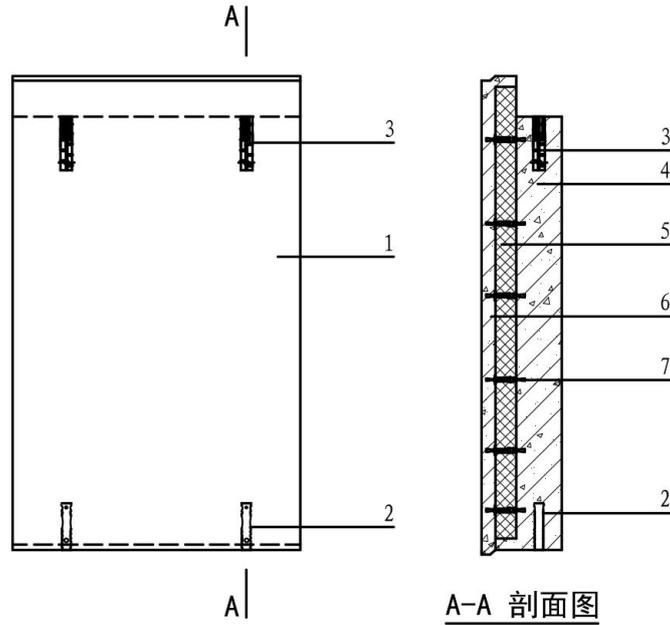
嵌挂结合式预制混凝土夹心外墙板构造示意图
